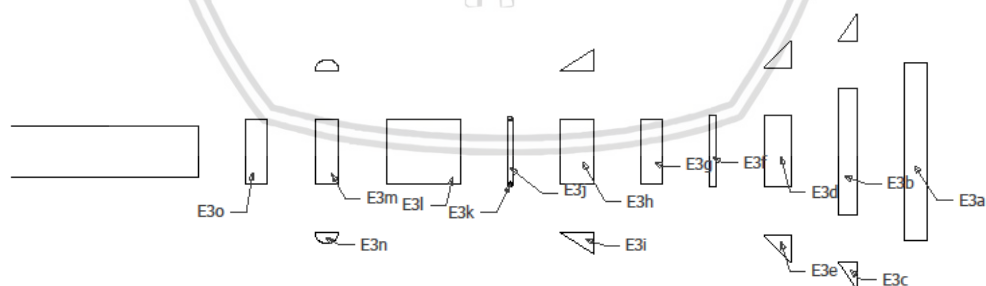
62 Bentuk kolom bangunan Desa Bungbungan
